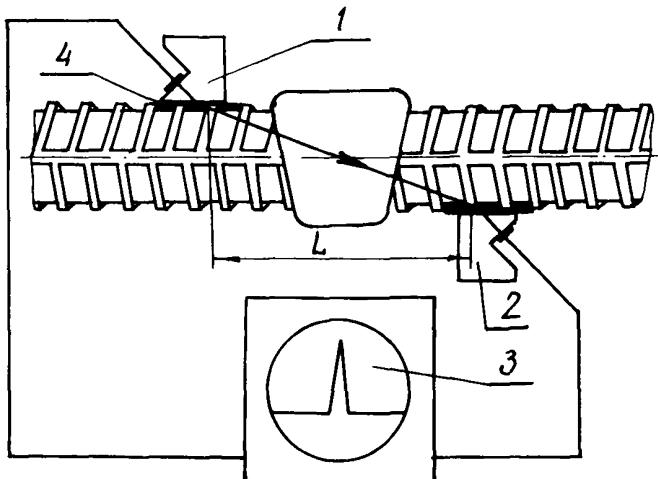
Схема ультразвукового контроля сварных стыковых соединений стержней, выполненных ванной сваркой.
